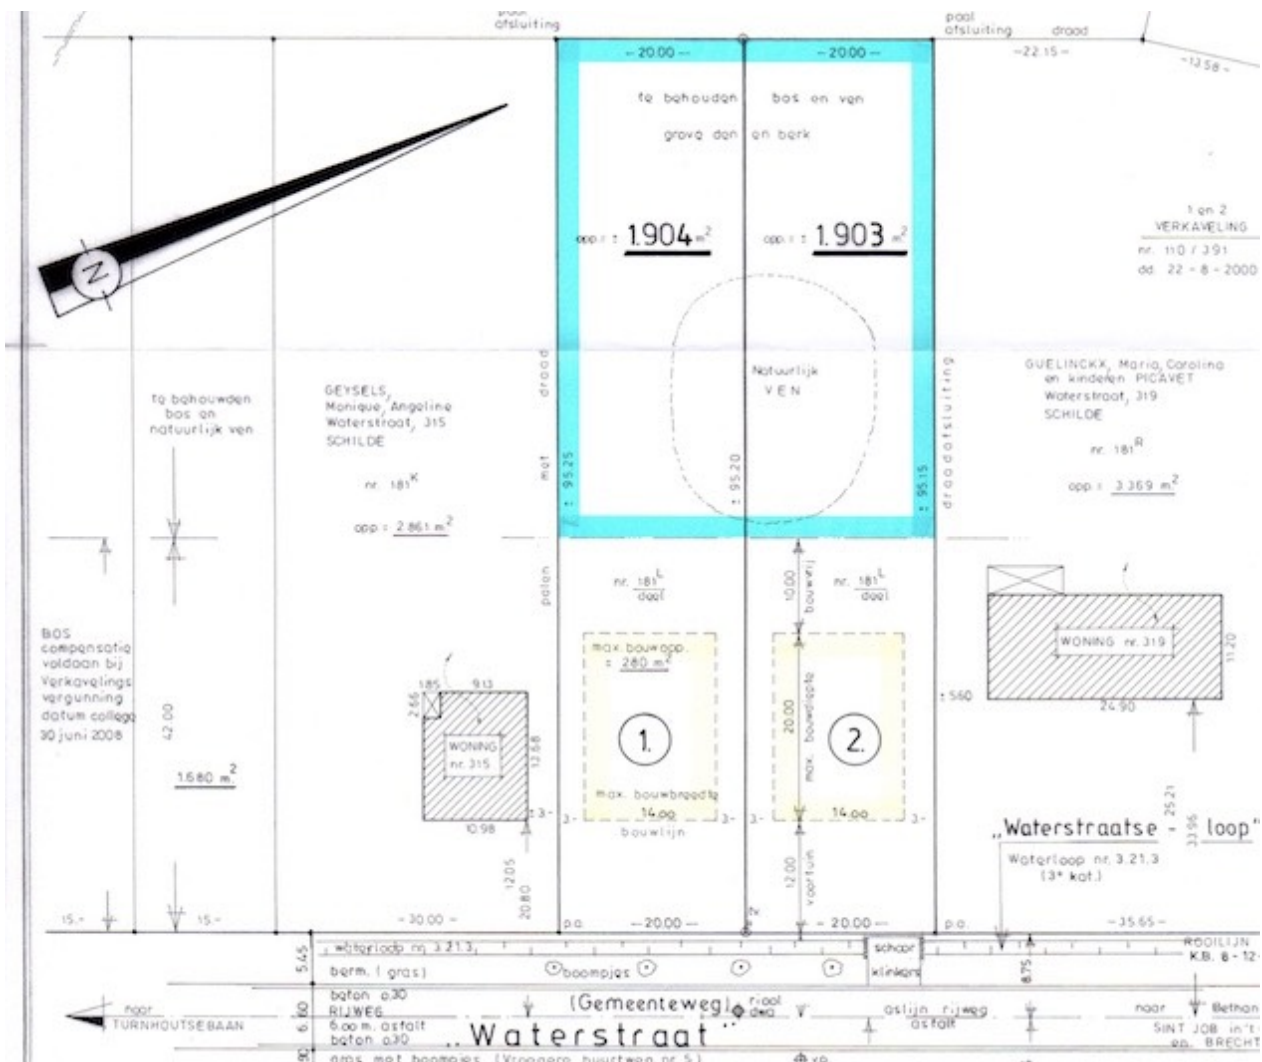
Plan 16. Plan van de geplande verdeling van de percelen. Op het verkavelingsplan wordt de plaats waar de gebouwen mogen worden ingeplant aangeduid. Het gaat om een suggestie met weergave van de maximaal toegelaten vloeroppervlakte voor de gebouwen. © Eric Van Hove
